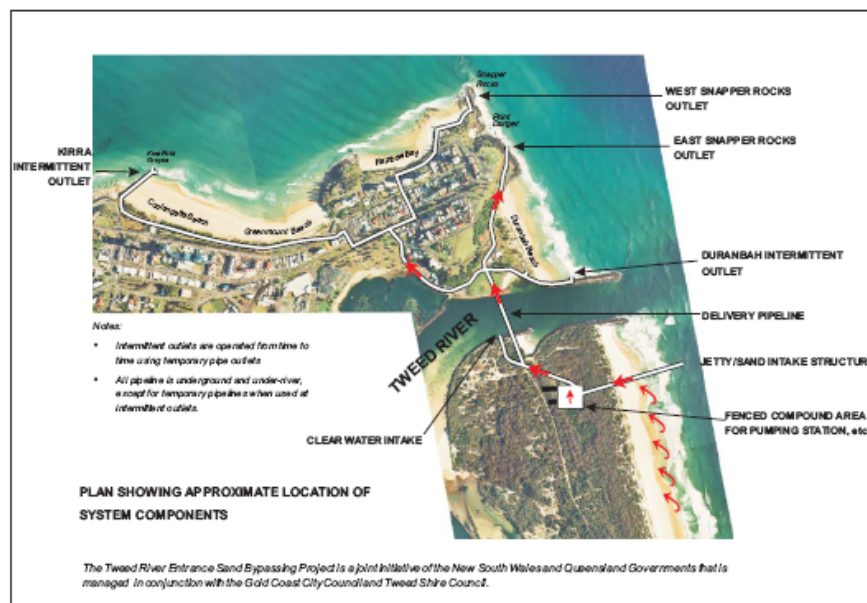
固定式抽砂養灘輸砂系統(Fixing Sand Bypassing System)
